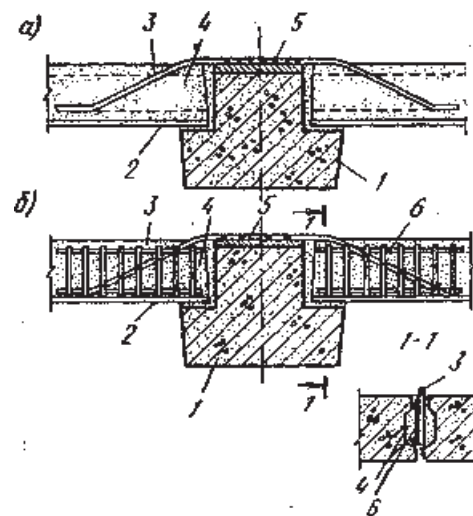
Соединения плит безопалубочного формирования по межплитным швам: а – с помощью отгибов; б – с отгибом и каркасом; 1 – панели;
